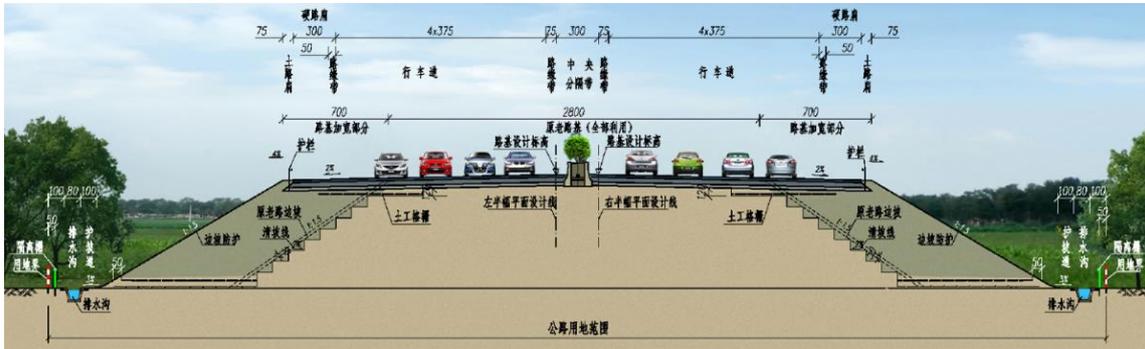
两侧拼宽为整体式路基断面 42 m
